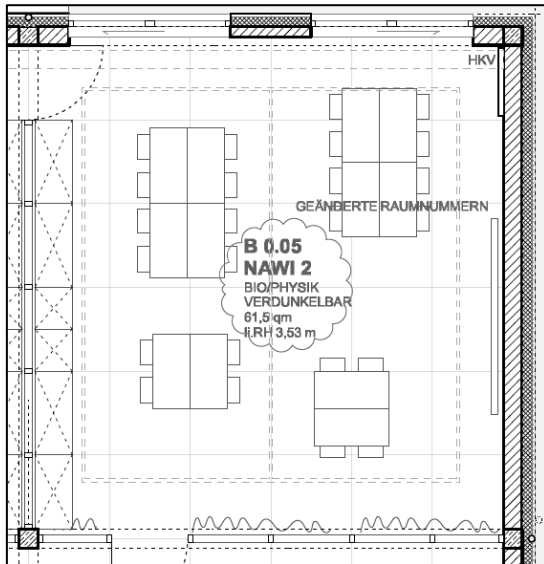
Grundriss NAWI 2, unmaßstäblich /12/
